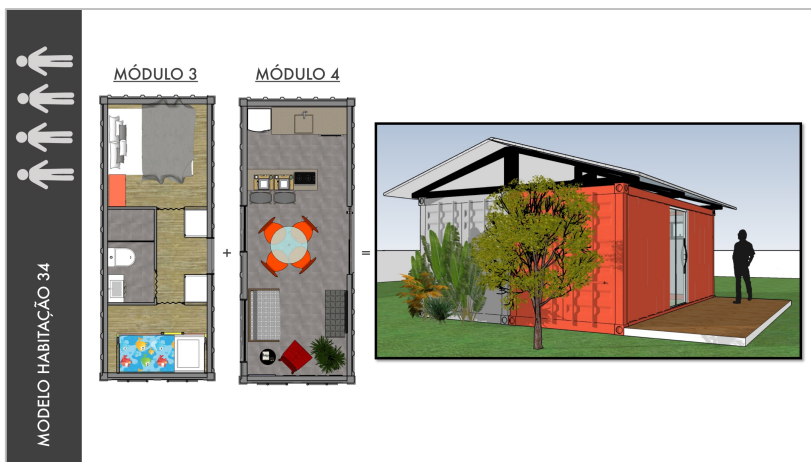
Modelo de habitação de dois módulos com telhado de estrutura metálica e cobertura verde
